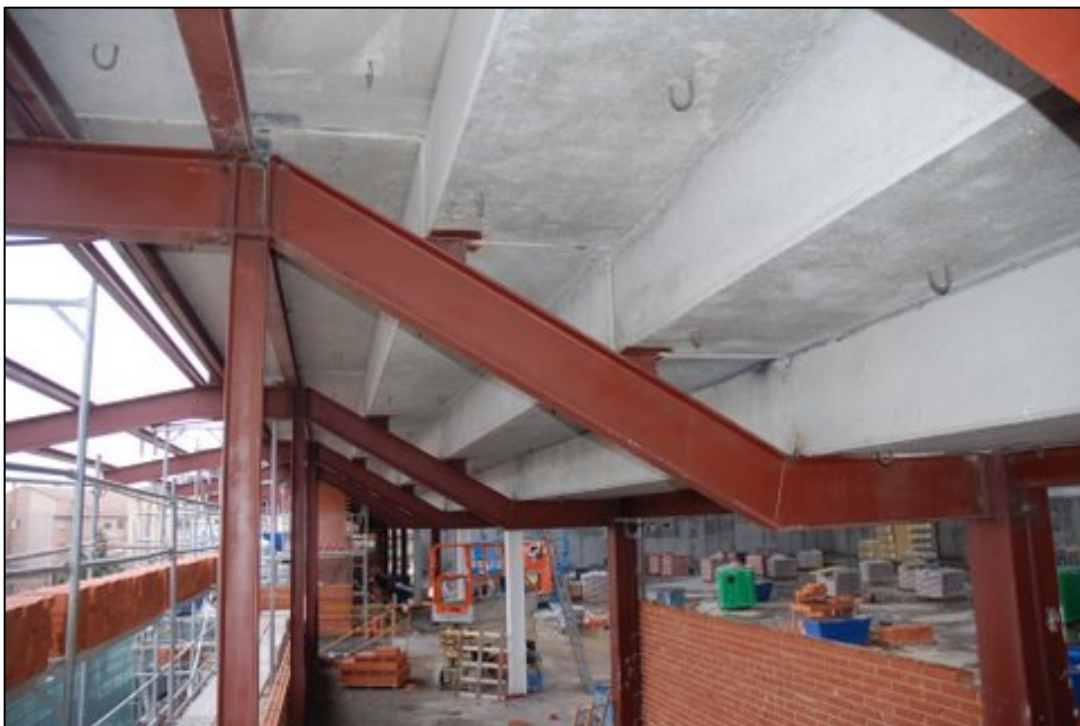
Ejemplo real de anclaje de los bloques de hormigón sobre los perfiles metálicos.
